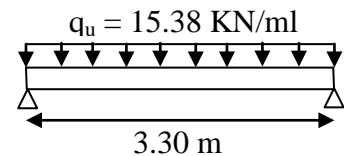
Schéma statique de la poutre de chaînage 1
